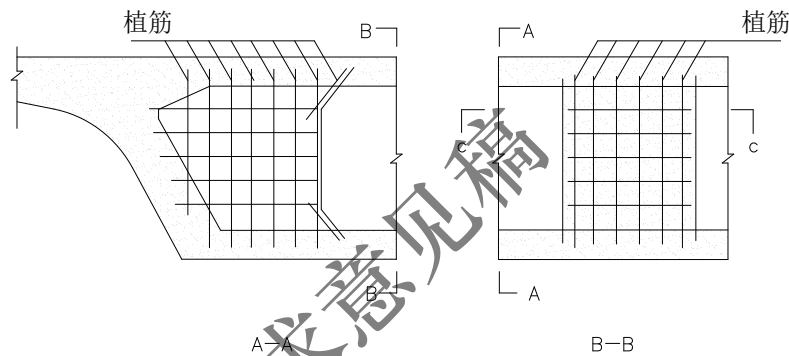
锚固横隔板受力钢筋布置示意图
